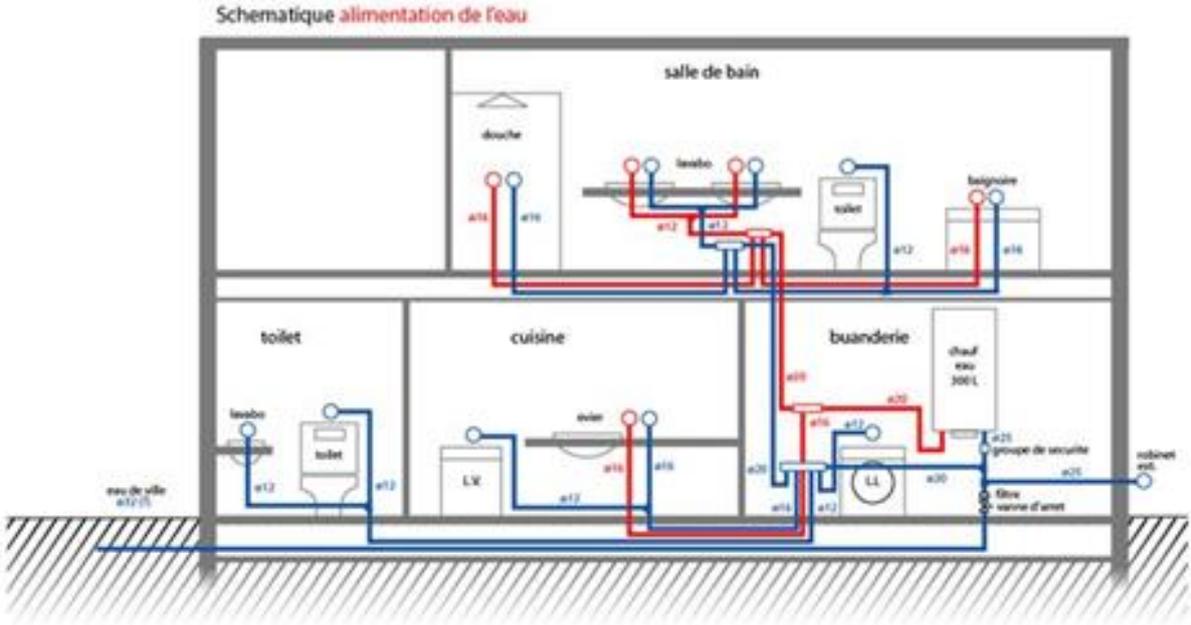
Une représentation en coupe d'une installation sanitaire
